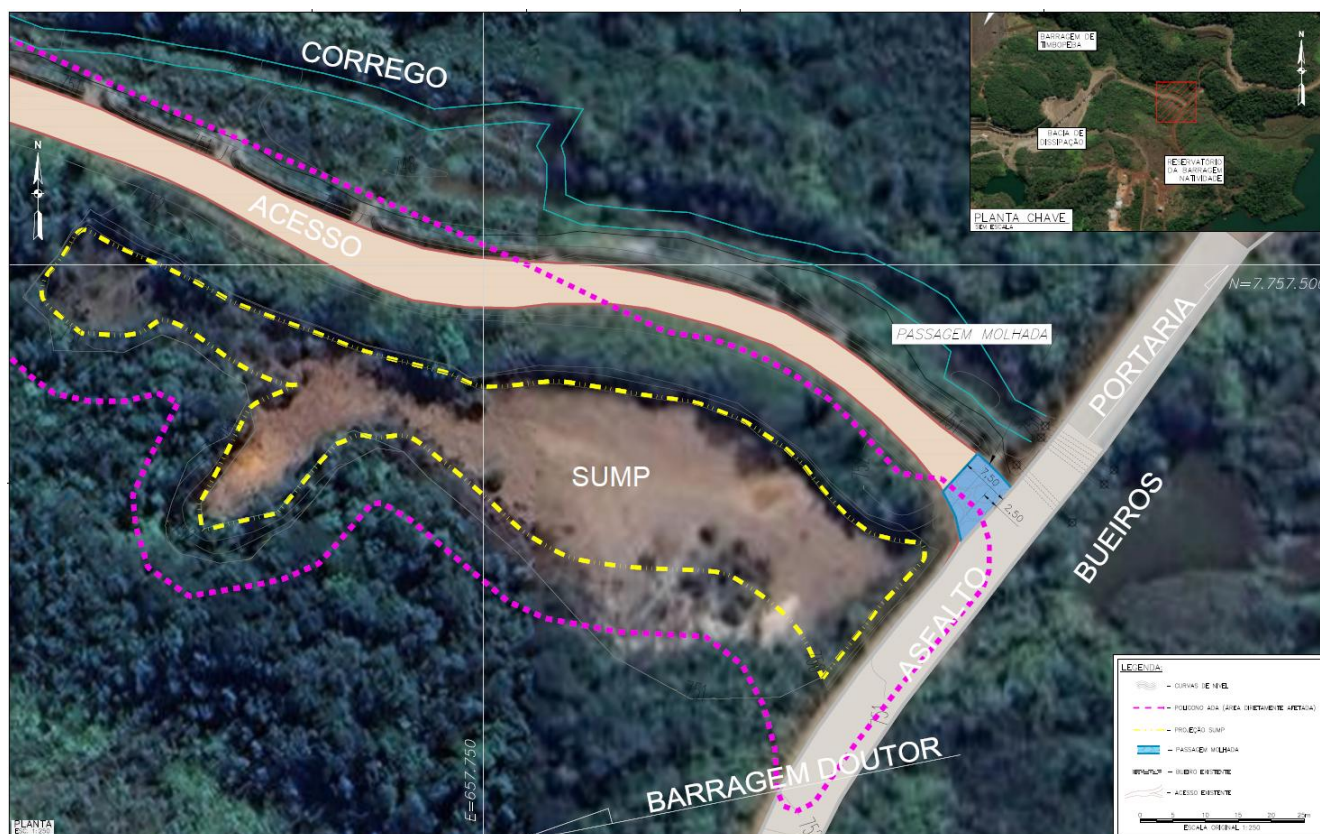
Planta geral da região sump com detalhe da área da passagem molhada a ser implantada (1000BB-X-15813).
